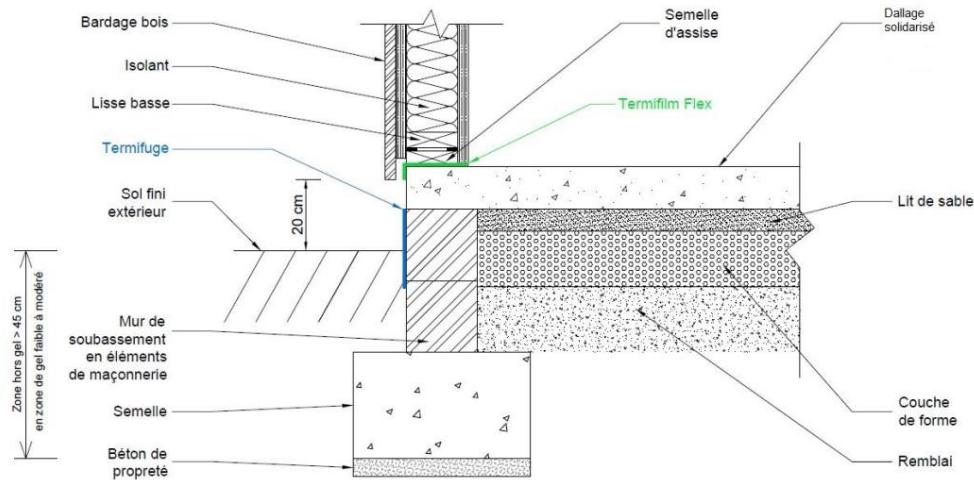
Dallage solidarisé/dalle portée et soubassement maçonnerie (Disposition non autorisée en zone sismique)
